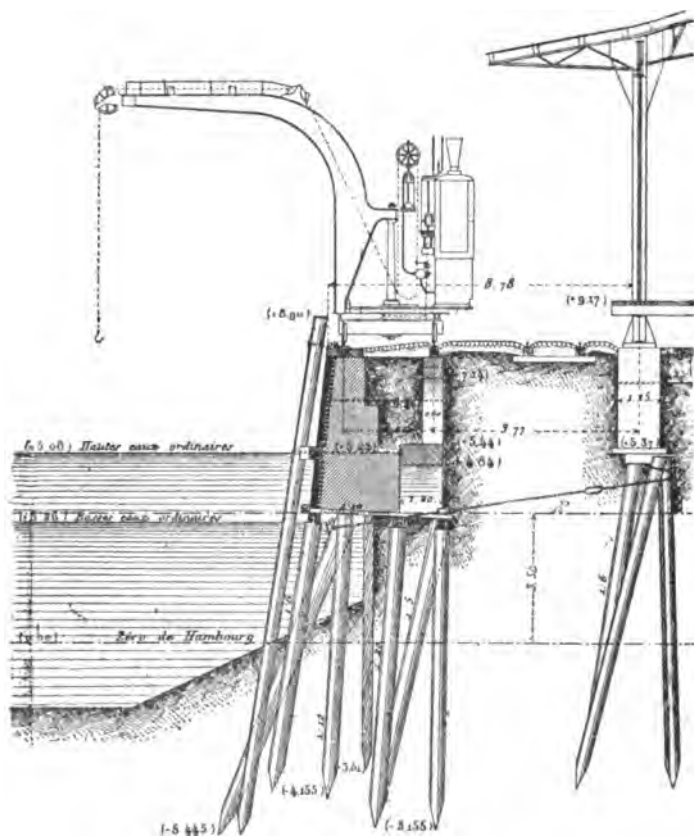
Hambourg. — Mur de quai de Sandtorhafen. Coupe transversale.
